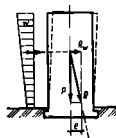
Схема устойчивой работы здания на ветровую нагрузку:
